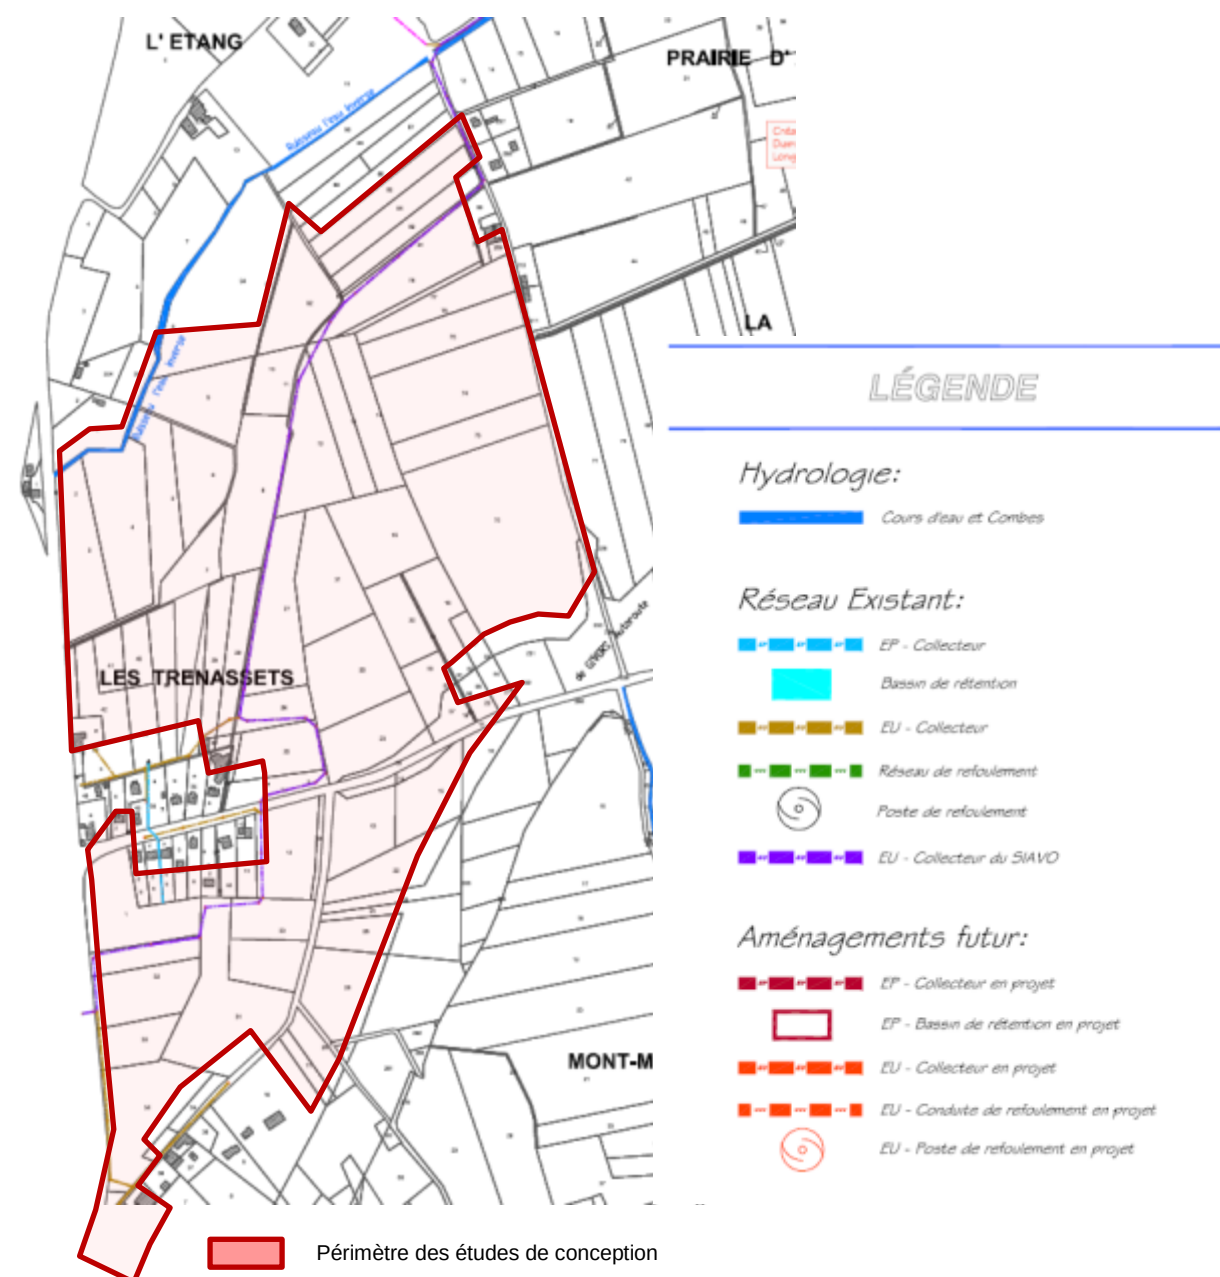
Réseaux d'assainissement et eaux pluviales, site des Trénassets
